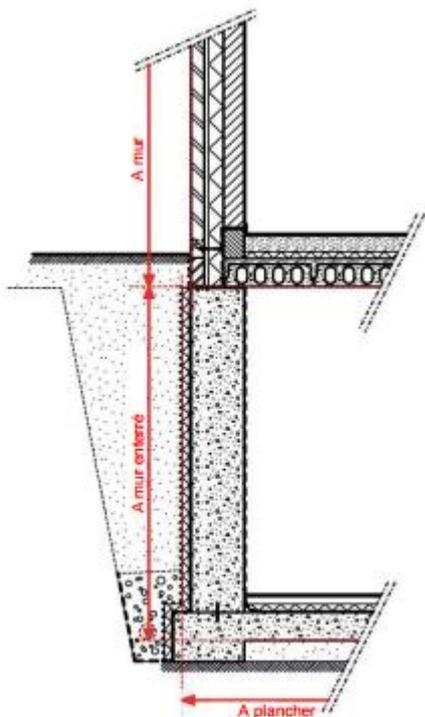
Mur extérieur – mur enterré – dalle contre terre lors d'une cave dans le VP
